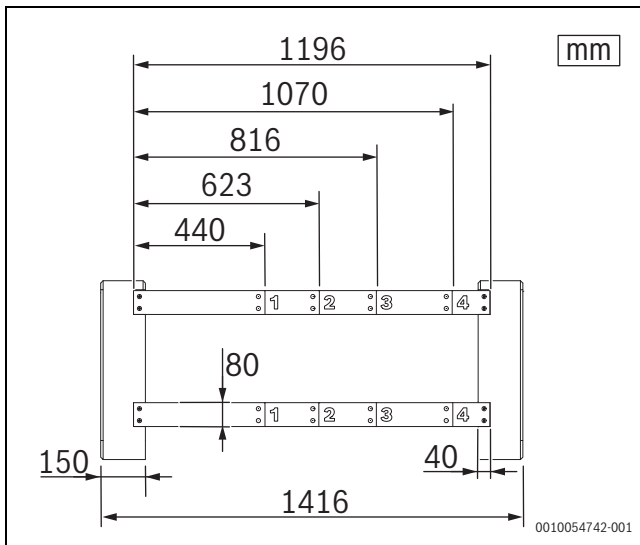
Abmessungen Fertigfundament (zusammgebaut)
